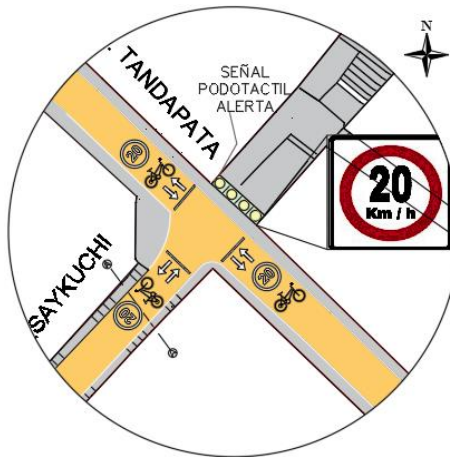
Pavimento táctil de alerta en la calle Atoqsaycuchi con Tandapata
